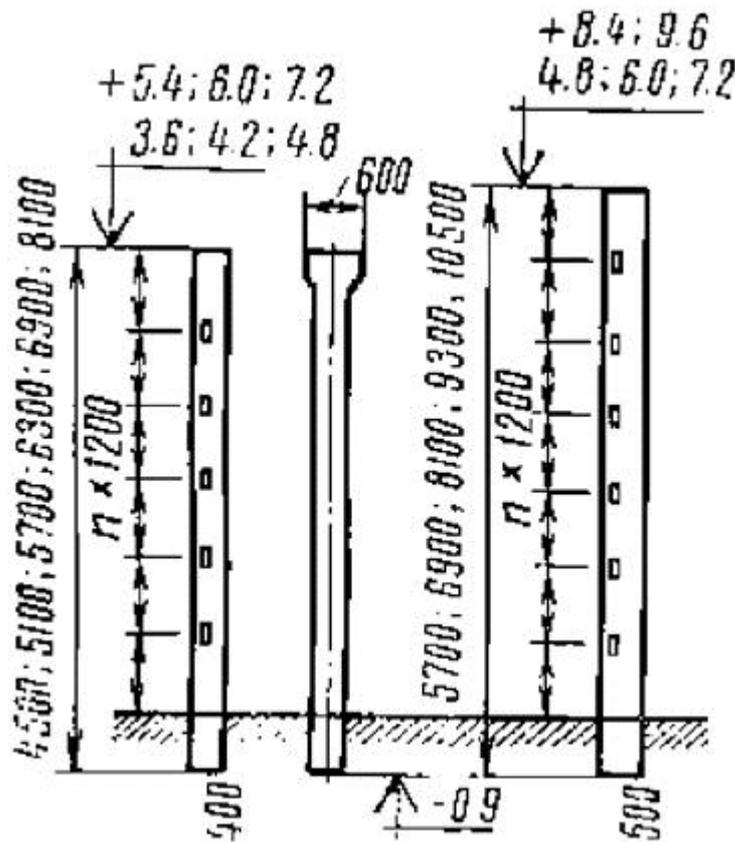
Залізобетонні колони для будівель без мостових кранів
